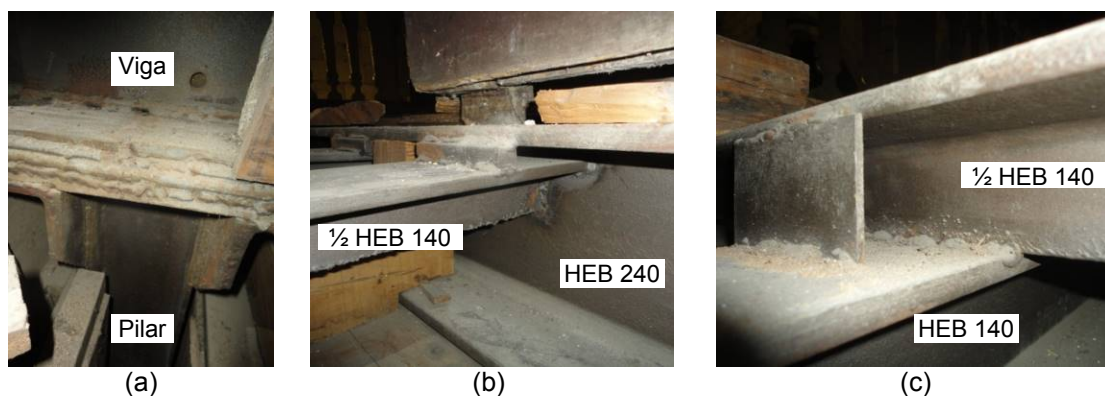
Pormenores das ligações soldadas: (a) viga-pilar dos pórticos; (b) 1/2 HEB 140-HEB 240 (pórtico 2); (c) 1/2 HEB 140-HEB 140 (pórtico 3).
